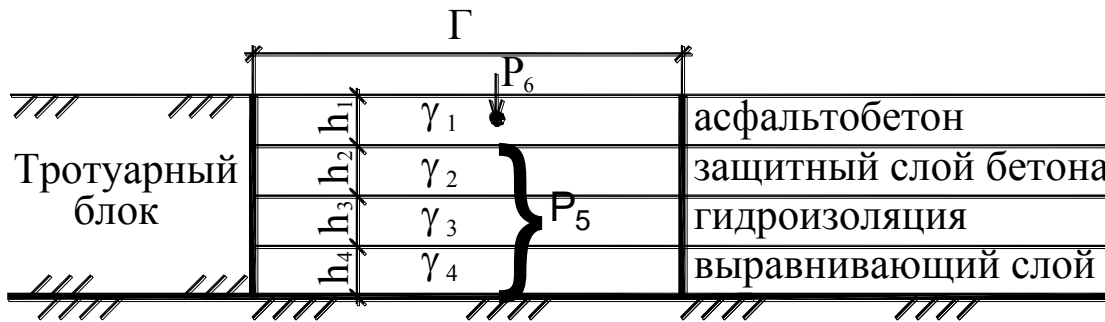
Схема трехслойного основания и асфальтобетонного покрытия
